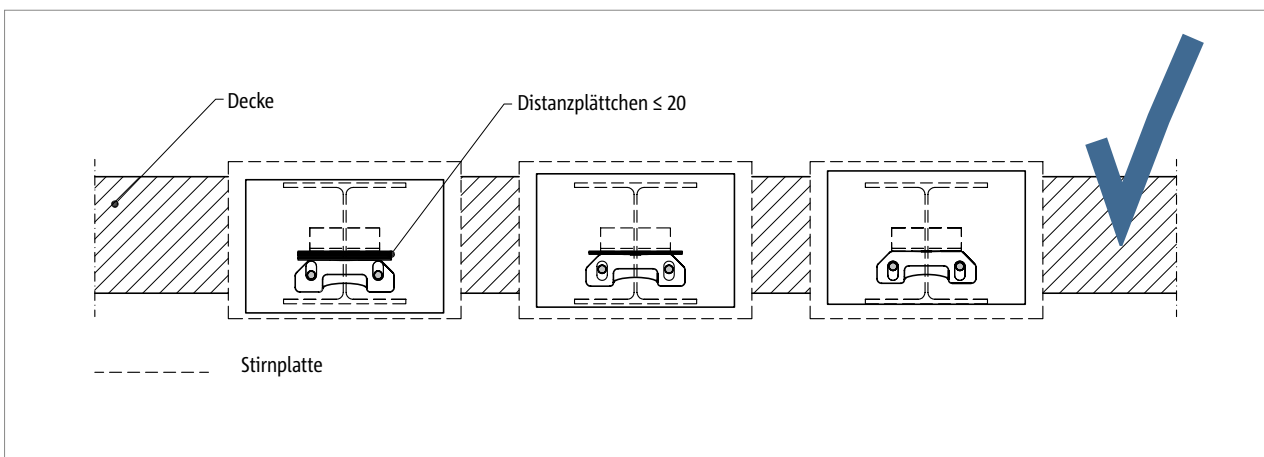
Schöck Isokorb® RT Typ SQ: Korrekter Einbau mit Verwendung der Bohrschablone ermöglicht das Erreichen der erforderlichen Einbaugenauigkeit
